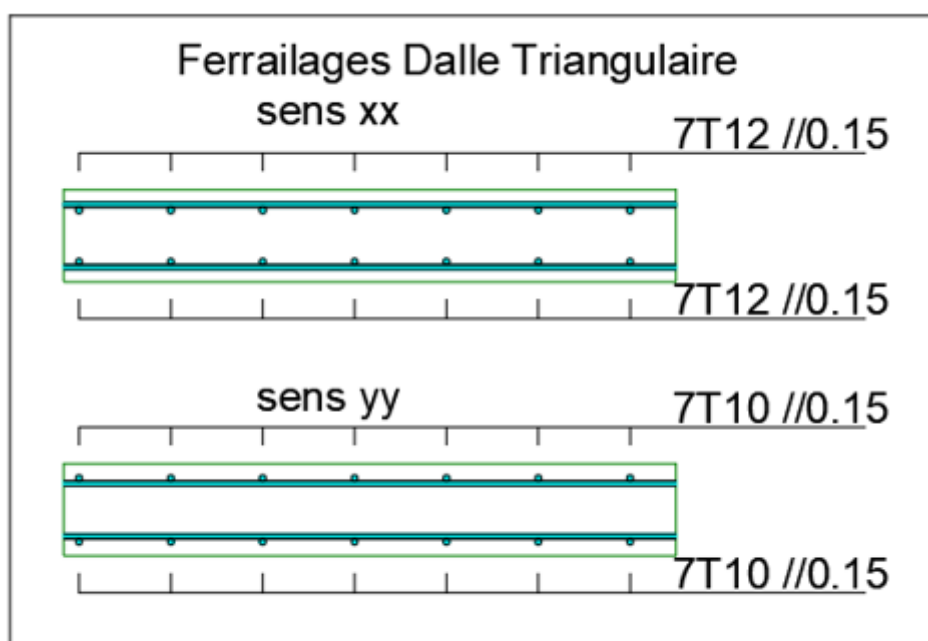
Plan de ferrailage de la dalle triangulaire.
